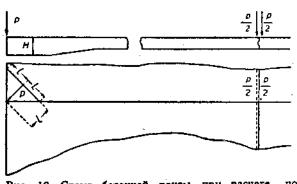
Схема бетонной плиты при расчете "по Ольдеру".
